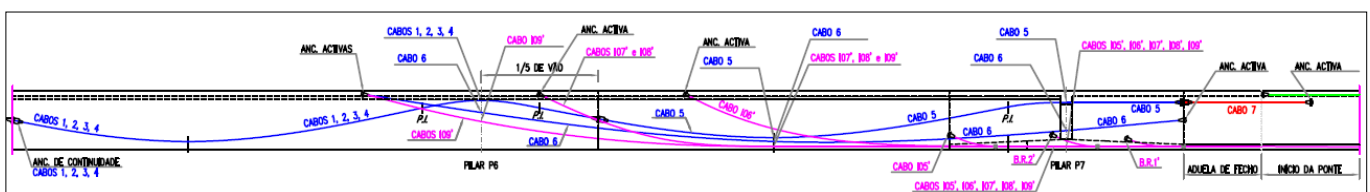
LIGAÇÃO DO VIADUTO CONSTRÚIDO DE TRAMO A TRAMO COM A PONTE CONSTRÚIDA POR AVANÇOS SUCESSIVOS
